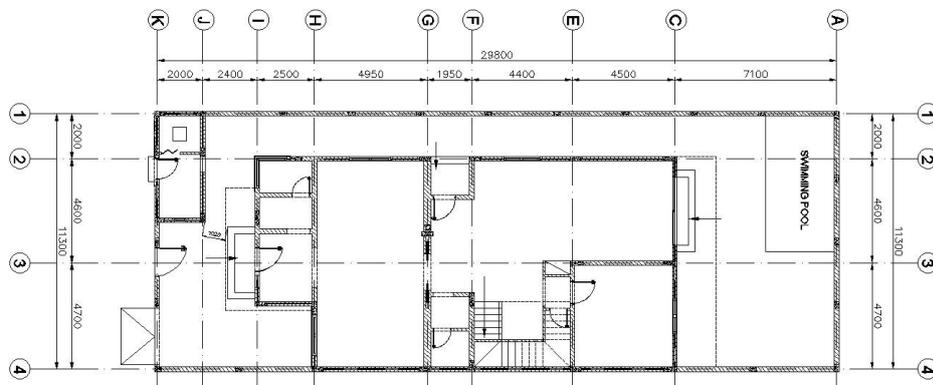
Planta baja arquitectónica. Proyecto Obhur.
